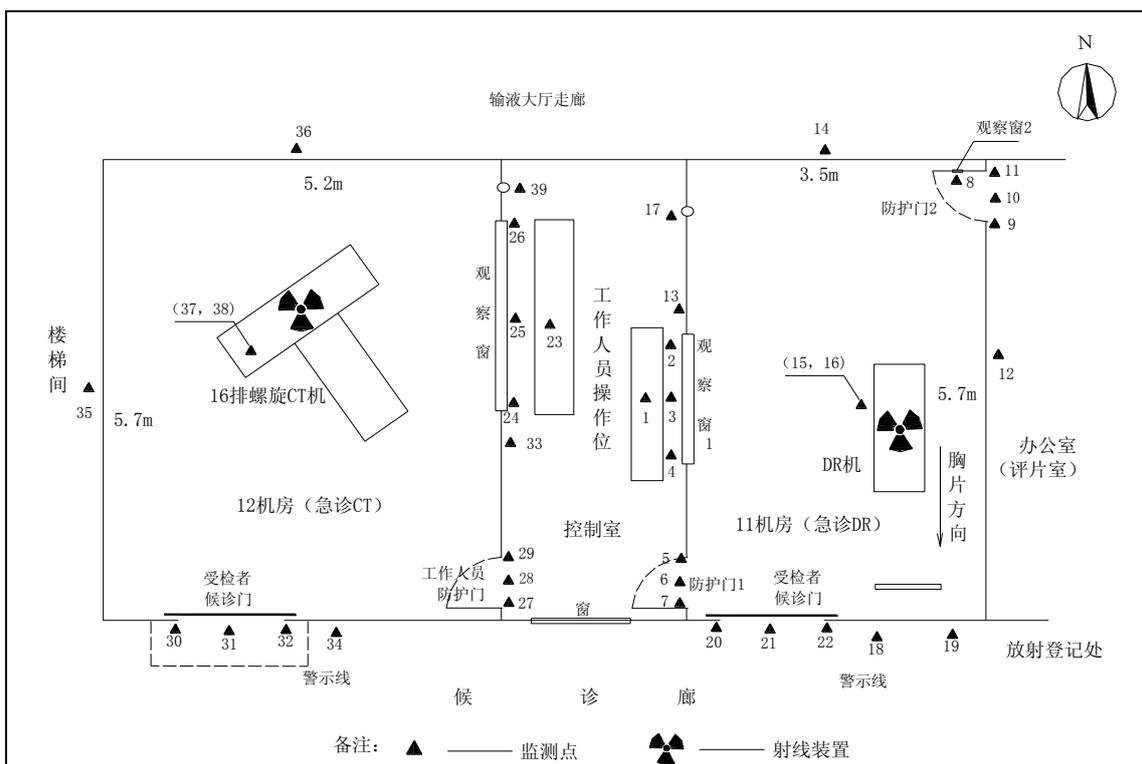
门诊楼 11 号和 12 机房现场监测点平面图
